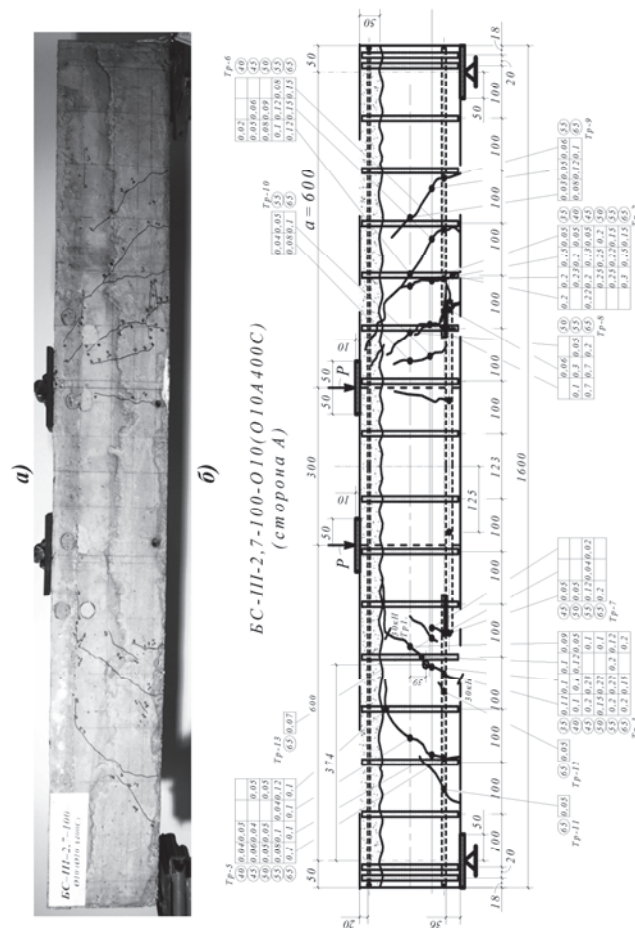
Схема трещинообразования в опытных конструкциях третьей серии (сторона А): а) фото железобетонной составной конструкции БС-III-2-7-100-010 (Ø10 А400С) после испытания; б) картина образования, развития и раскрытия трещин на уровне продольной и поперечной рабочей арматуры; на удалении трех диаметров от нее; на уровне 0,5 высоты сечения и на берегах шва в той же конструкции
